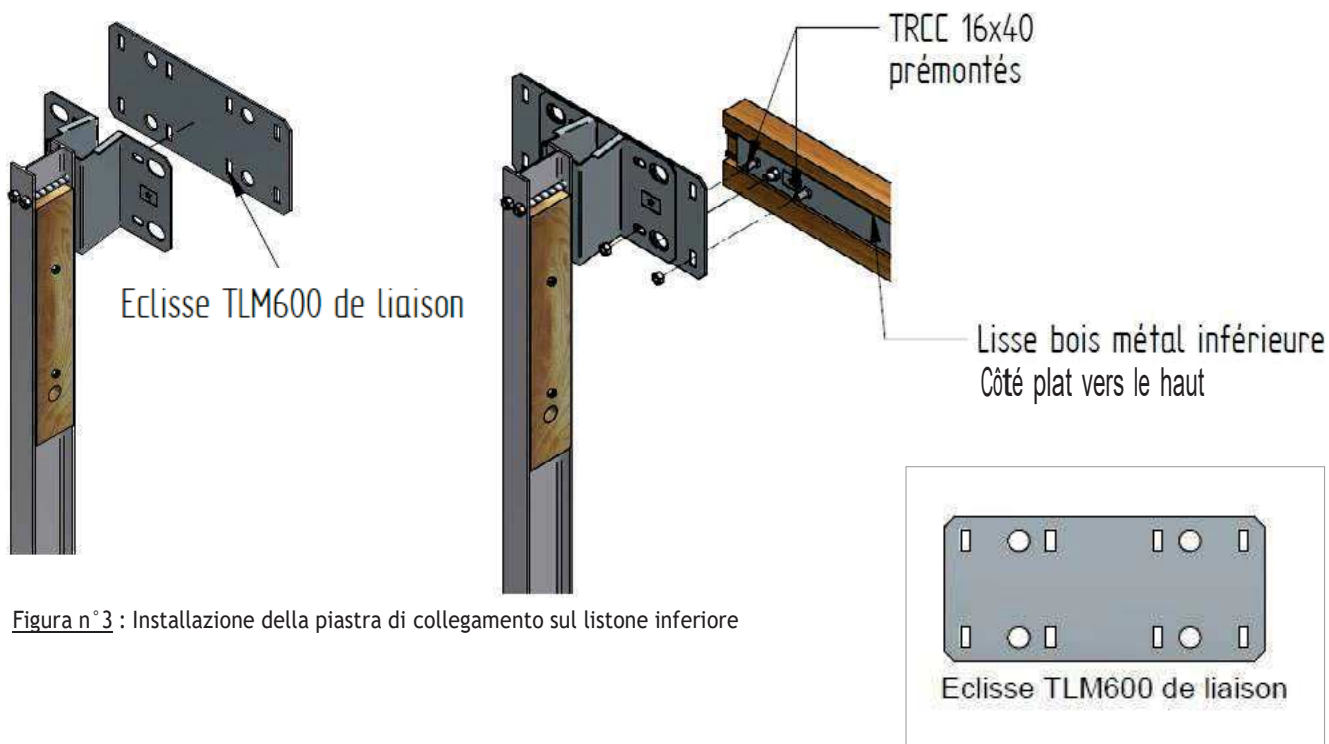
Installazione della piastra di collegamento sul listone inferiore
